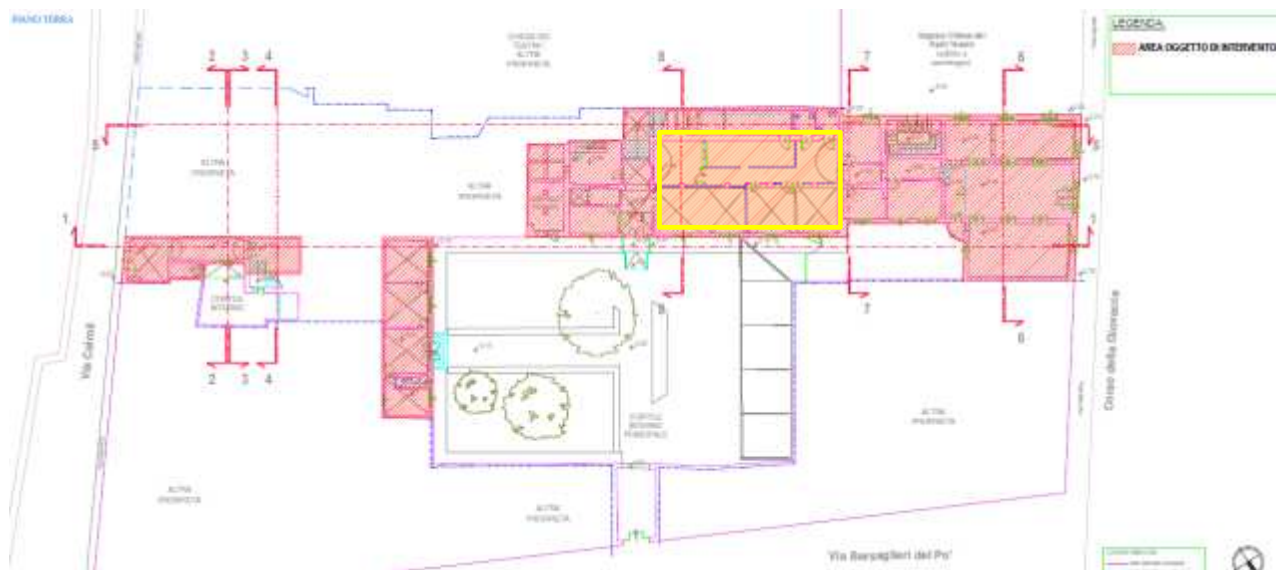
Planimetria P.T. con indicazione in giallo ubicazione struttura intelaiata
